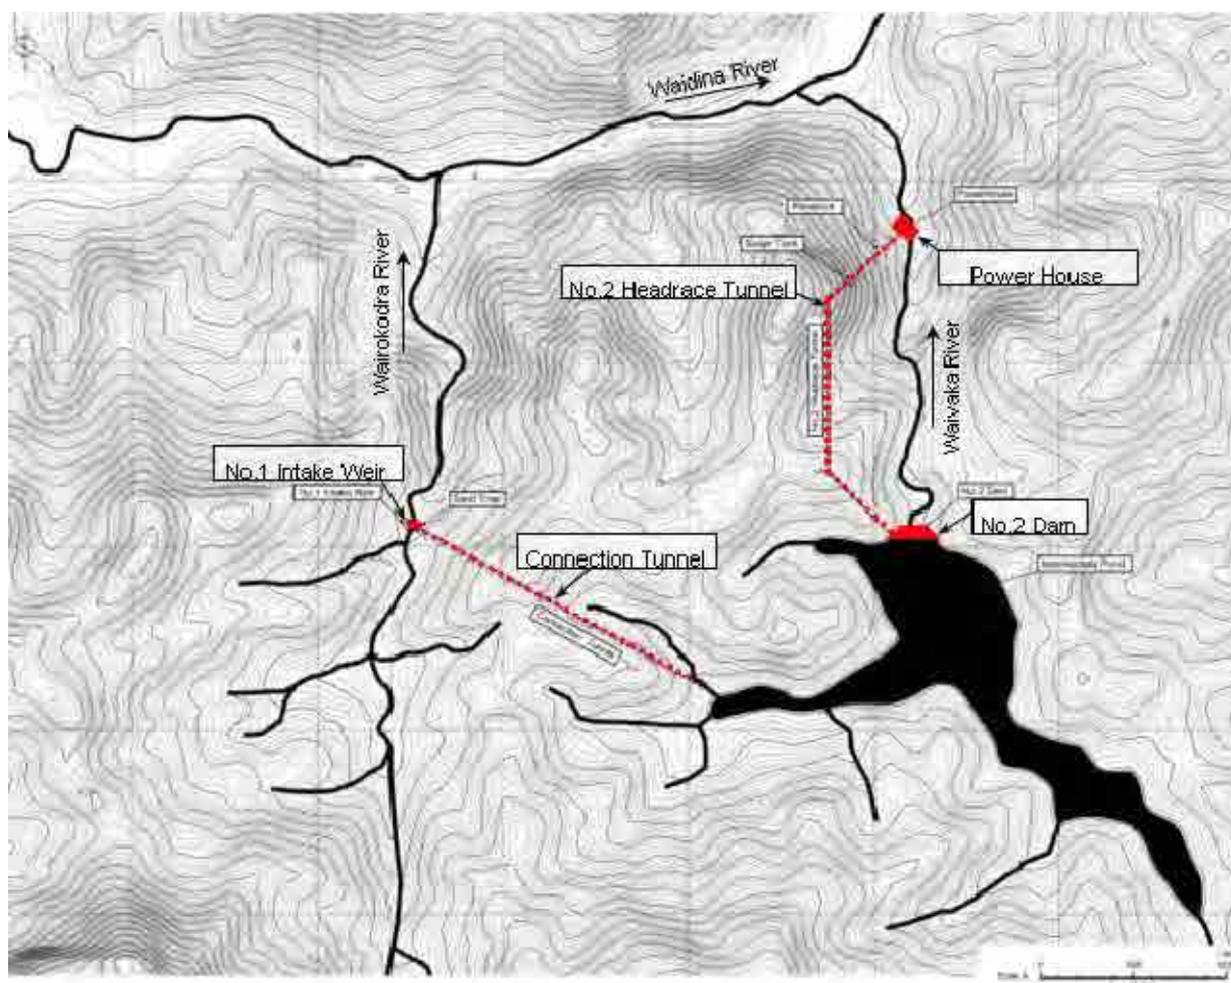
No.29 Waivaka 水力発電計画一般平面図
